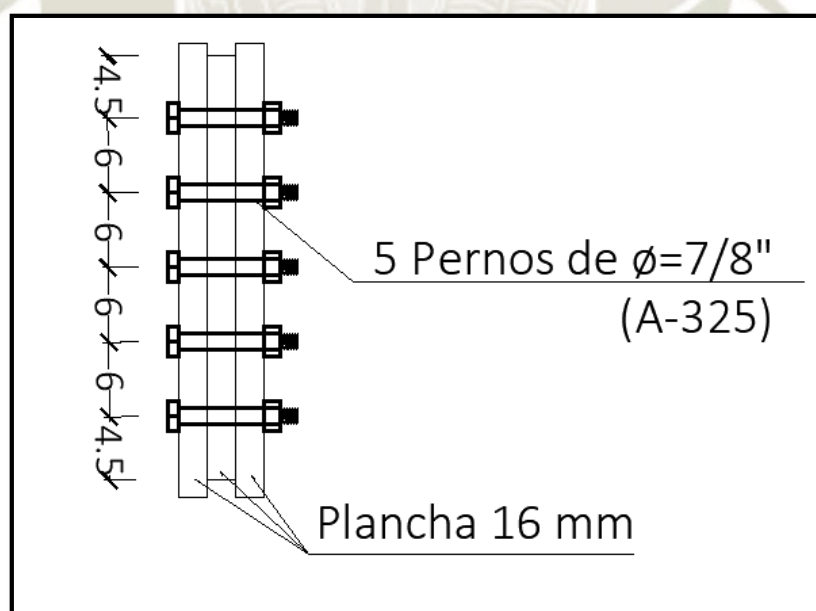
Corte transversal 1 de Detalle 1. (Fuente: Elaboración propia)
